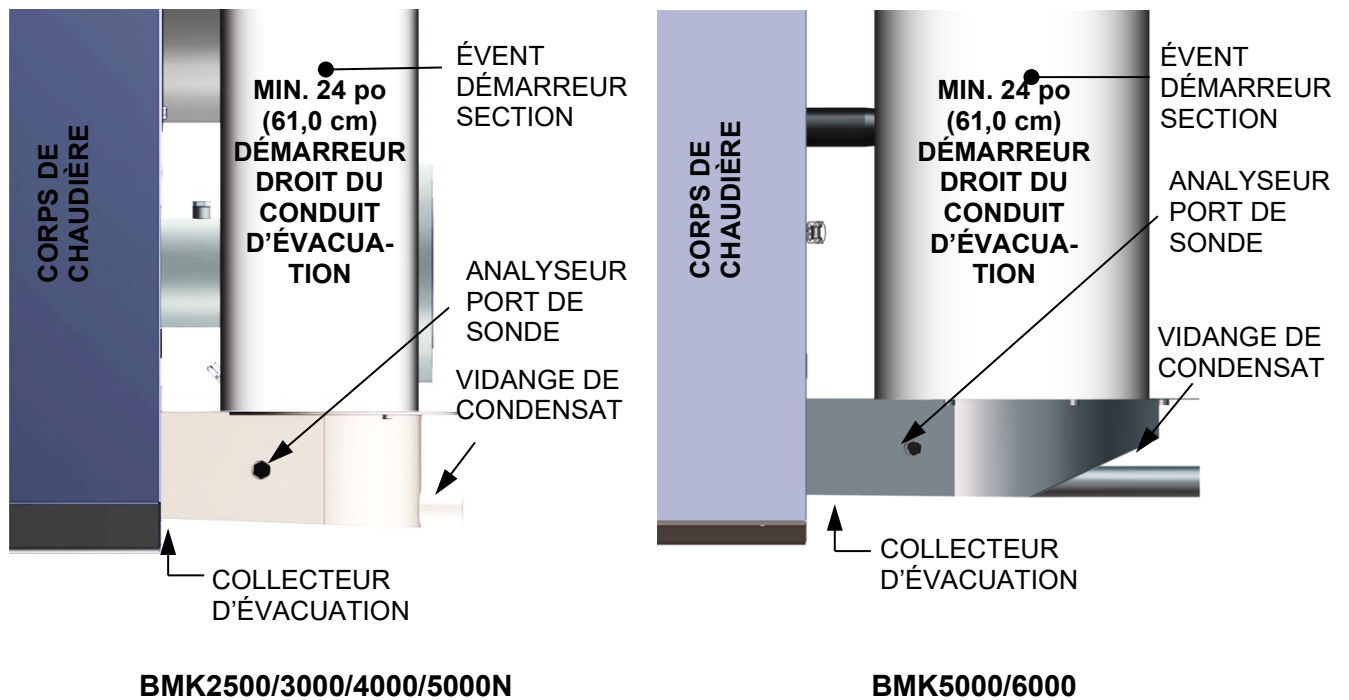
section du démarreur du conduit d'évacuation : vue latérale gauche
